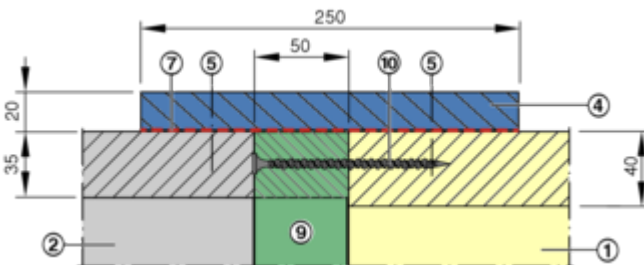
Einbaudetail B1: Anschlussrahmen an Bedien-seite (außen bündig)
